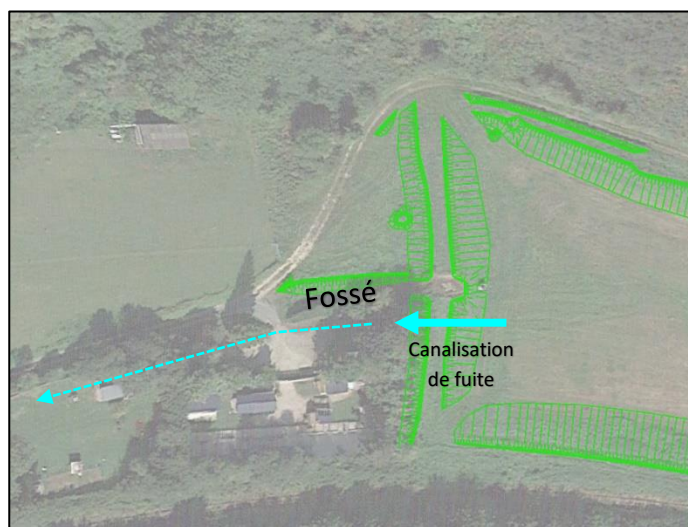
Vue en plan de l'exutoire final existant de l'ouvrage.
